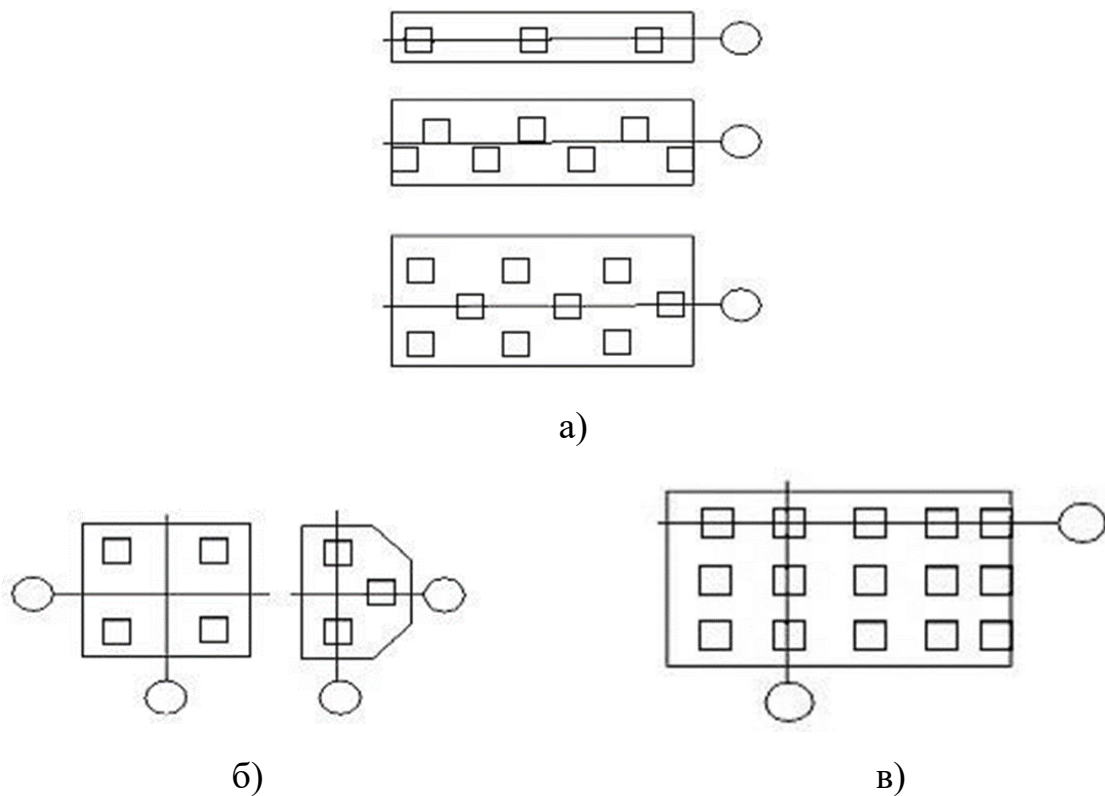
Схеми розташування паль в ростверках: а – в стрічковому; б – кущовому; в – суцільне пальове поле (суцільна плита)
